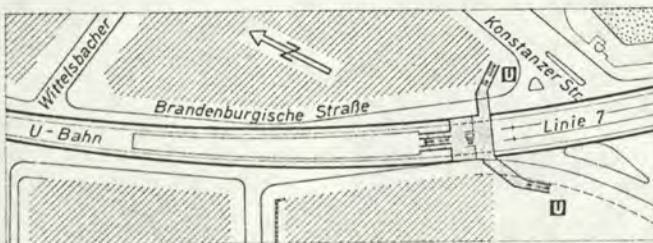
U-Bahnhof Konstanzer Str., Lageplan
